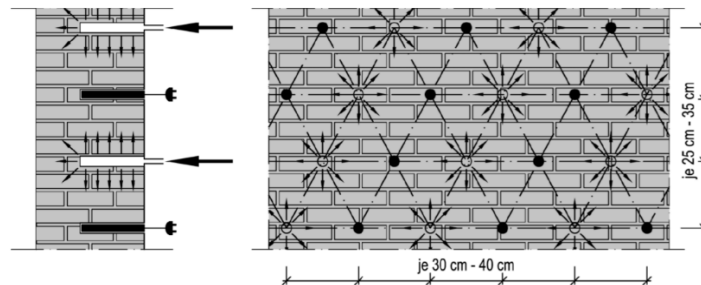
Heizstabtechnik kombiniert mit konditionierter Druckluft
